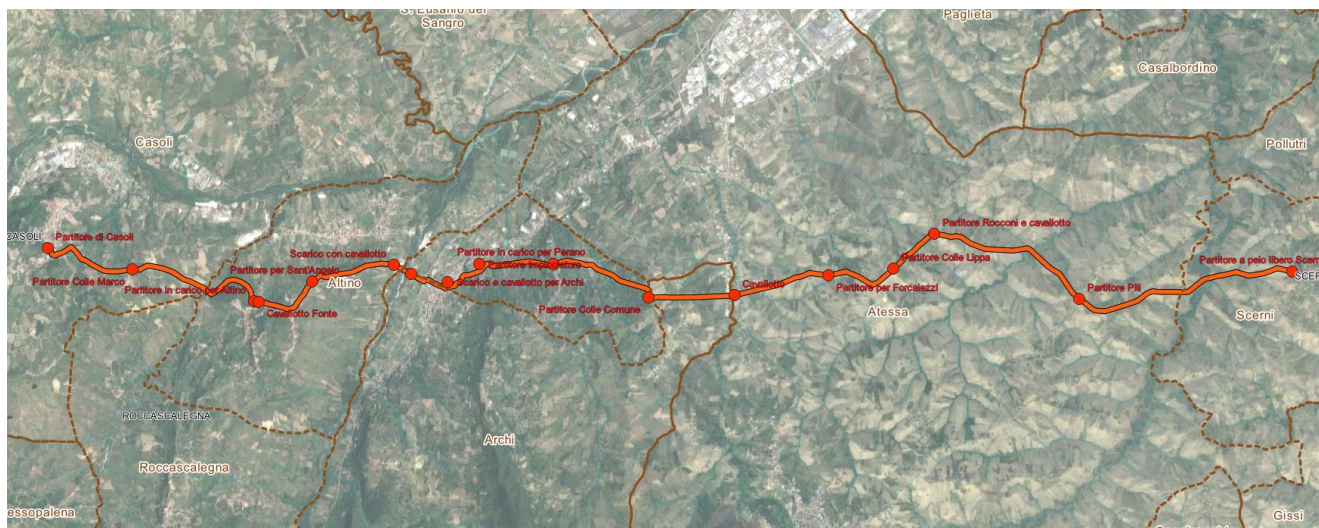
Planimetria di progetto su base ortofoto e schematizzazione modellistica
